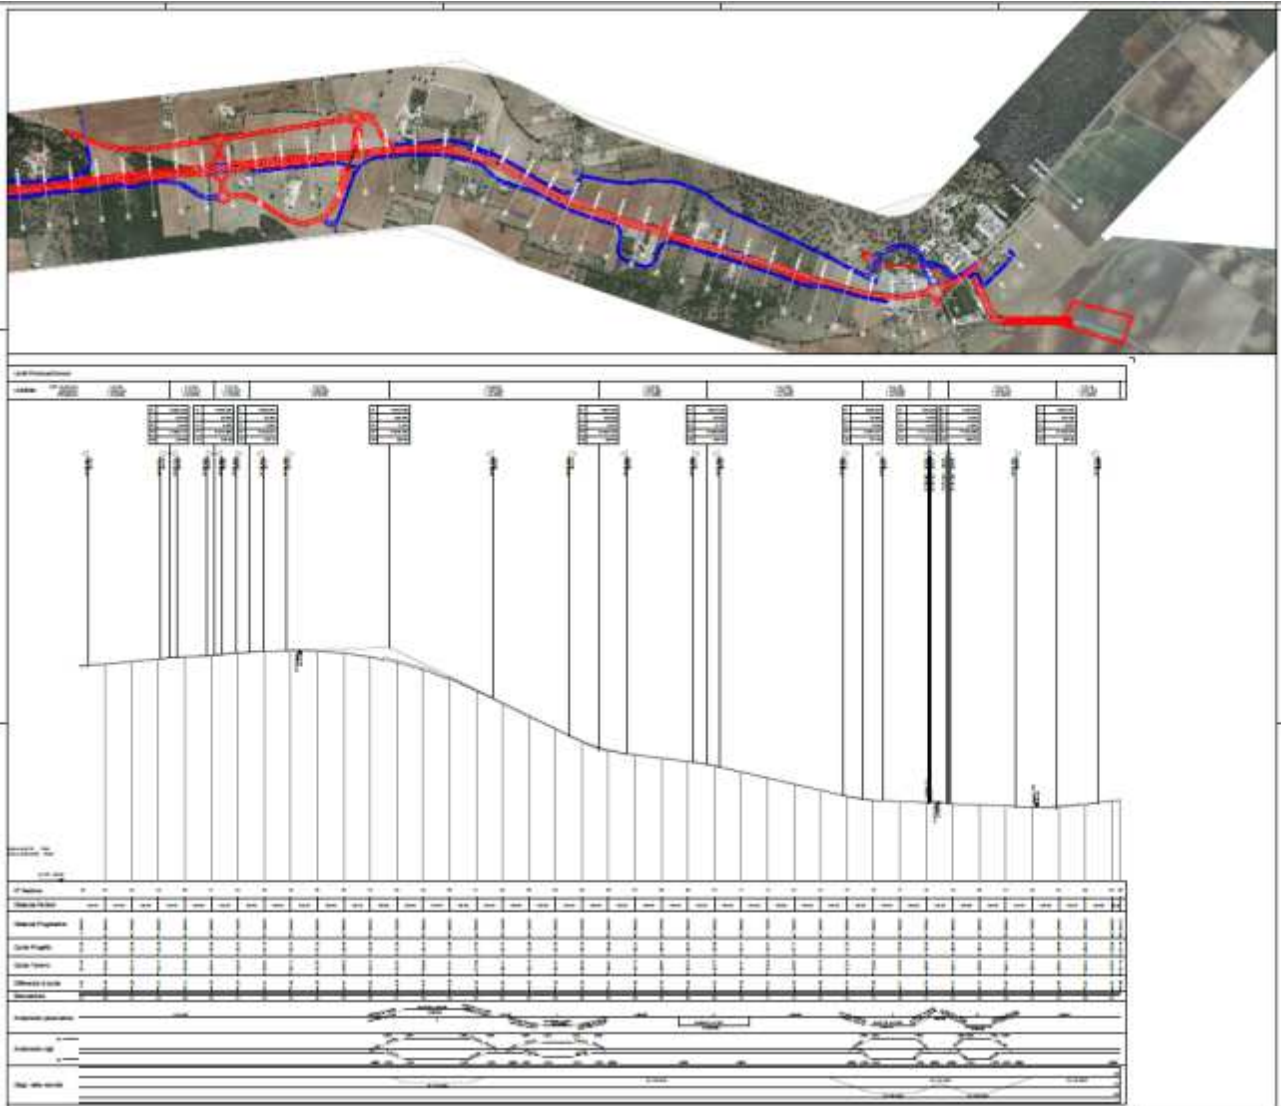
Tratto 2 da sezione 4+500 a fine intervento in località San Basilio
